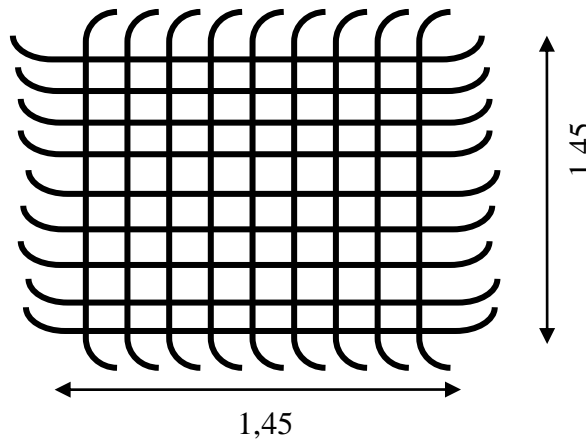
Vue en plan d'un croqué de ferrailage de la semelle
